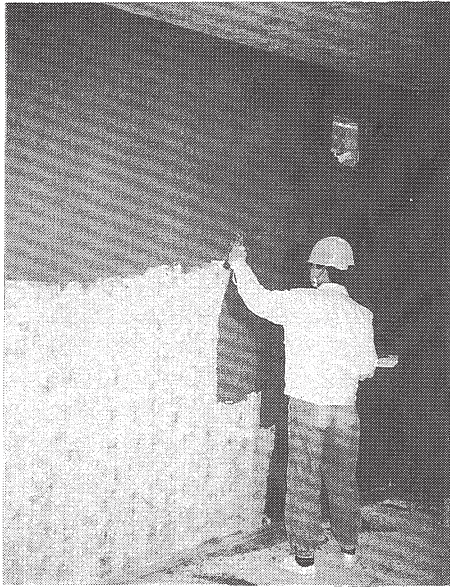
石炭灰砂製プレミックスモルタルの施工現場
